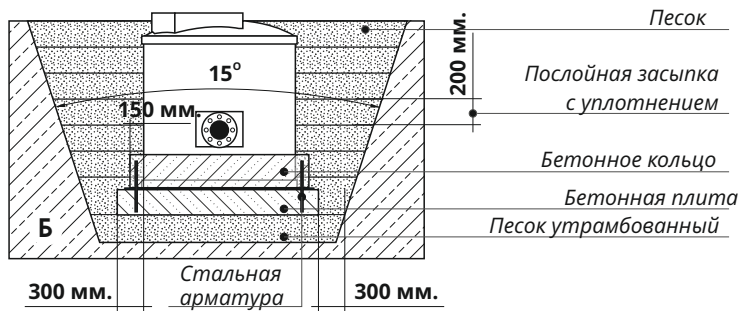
Схема монтажа КНС в грунтах с высоким уровнем грунтовых вод.
